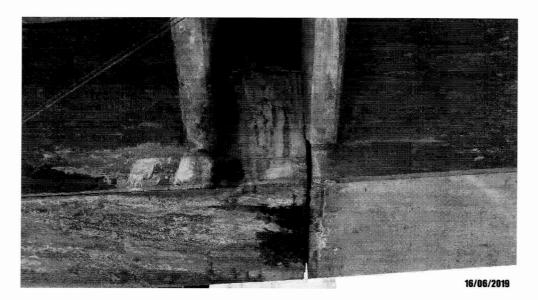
Detalhe da face inferior da viga com armadura exposta, eflorescência e desplacamento de concreto na junta de dilatação.
